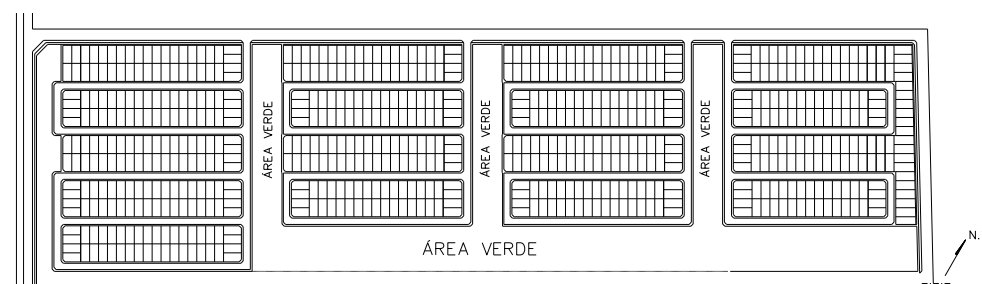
Projeto de implantação do Conjunto José Maria de Melo em 1979 (COHAB).
